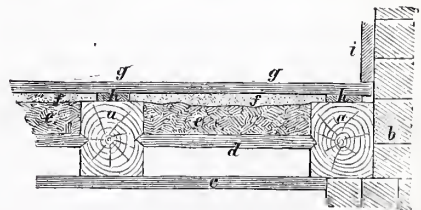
Balkendecke mit Quereinschub in Ruthen.
